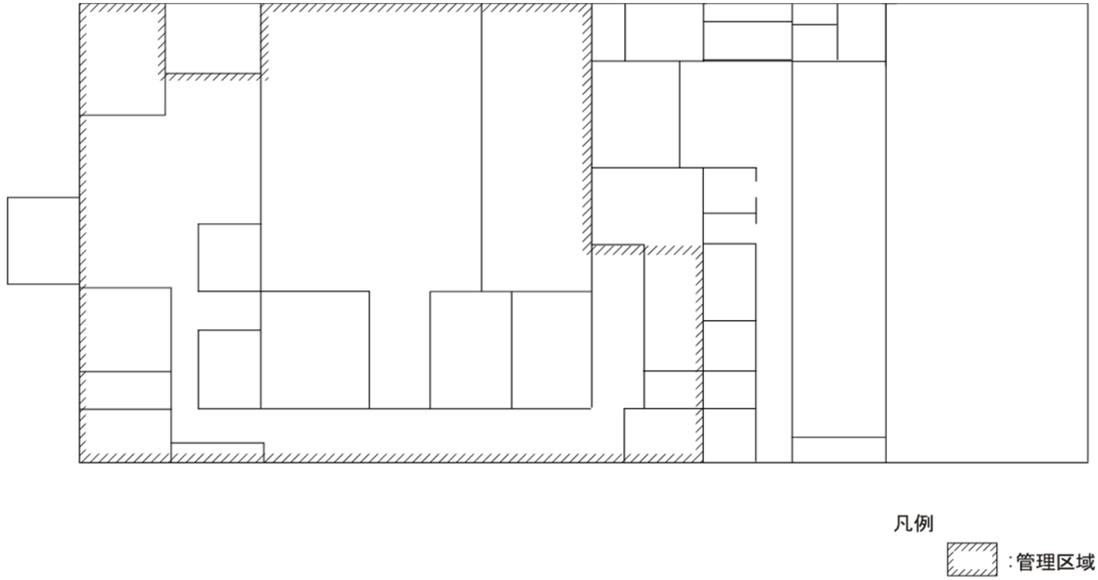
プルトニウム廃棄物処理開発施設1階平面図
